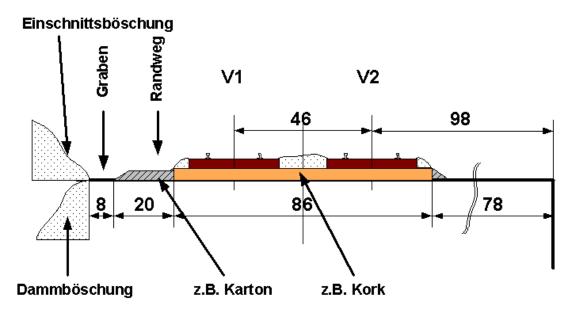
Bahnkörper für zweigleisige Strecke (gerade Strecke)
